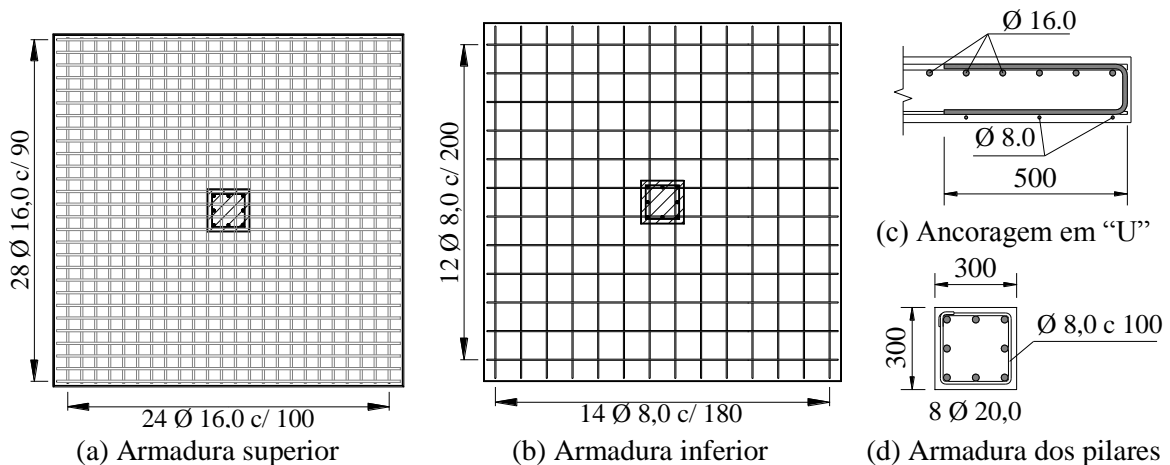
Detalhamento das armaduras de flexão das lajes
